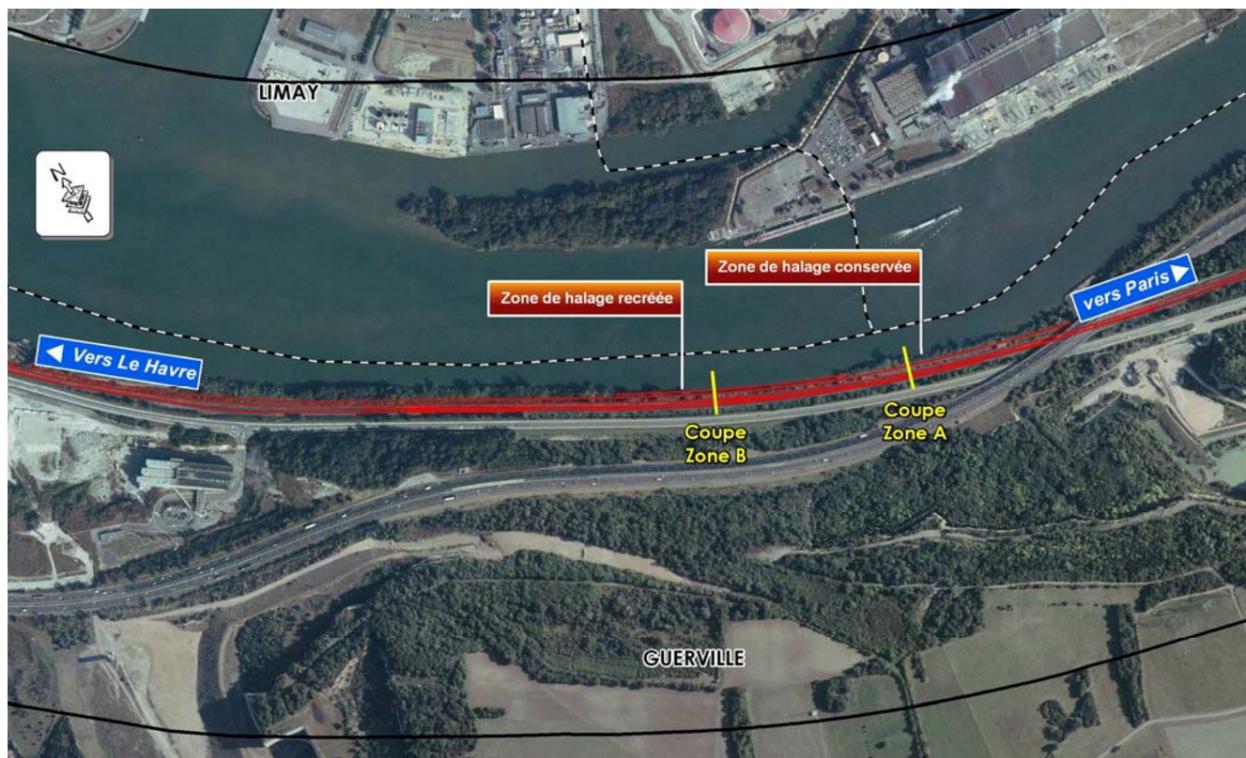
Situation des coupes présentant l'élargissement de la plateforme ferroviaire pour installer le prolongement de la 3eme voie
